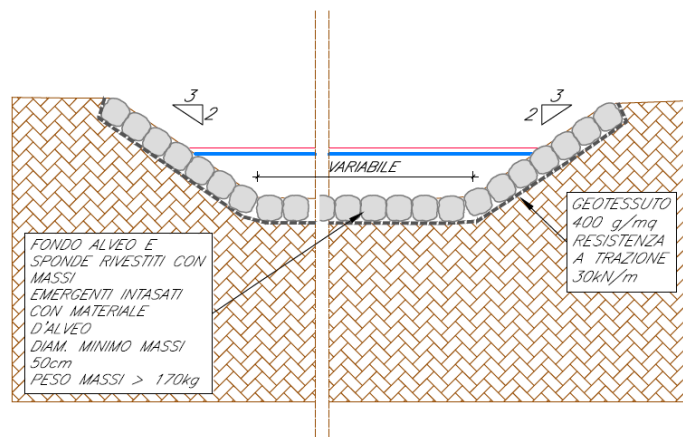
Sezione tipo sistemazione Pk 13+300.
